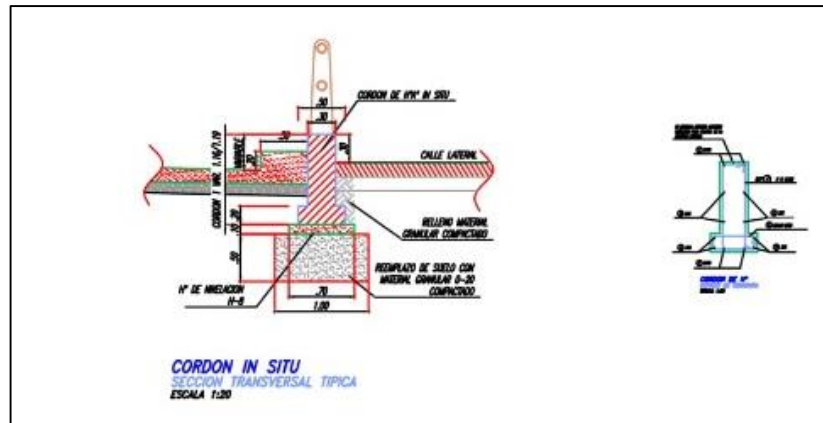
Sección transversal de los cordones de hormigón. (PLANO N° 26)
